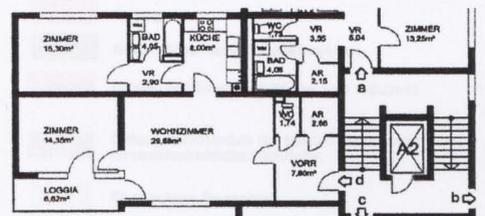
Grundriss Jakob-Gschielg. A2 Westwohnung
